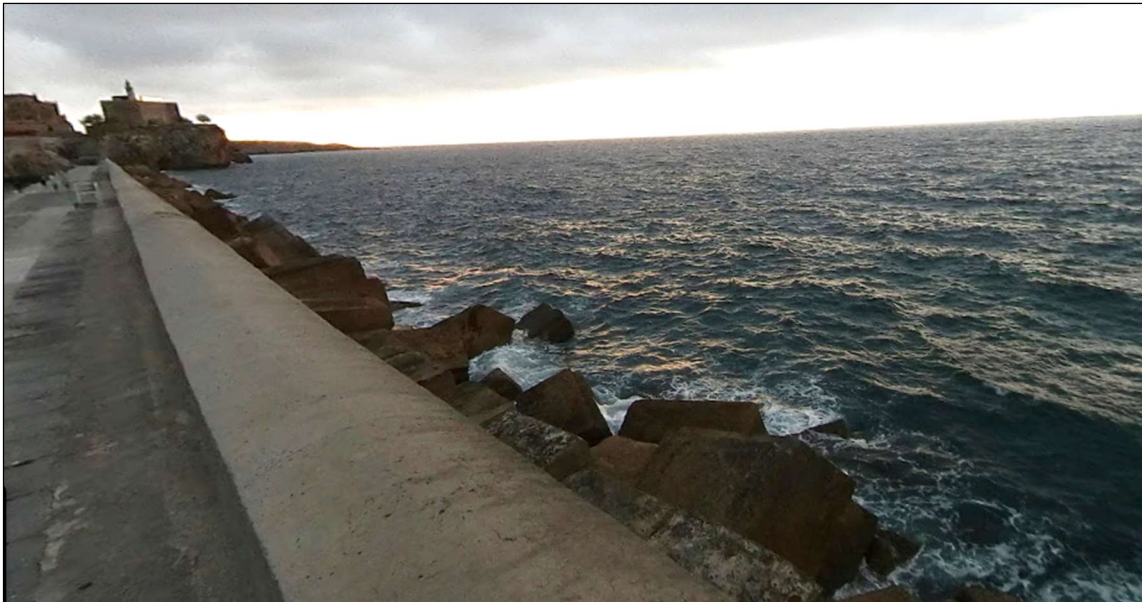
Fotografía de la parte norte del dique, donde aparecen los bloques de hormigón que conforman la protección lateral de la estructura.
